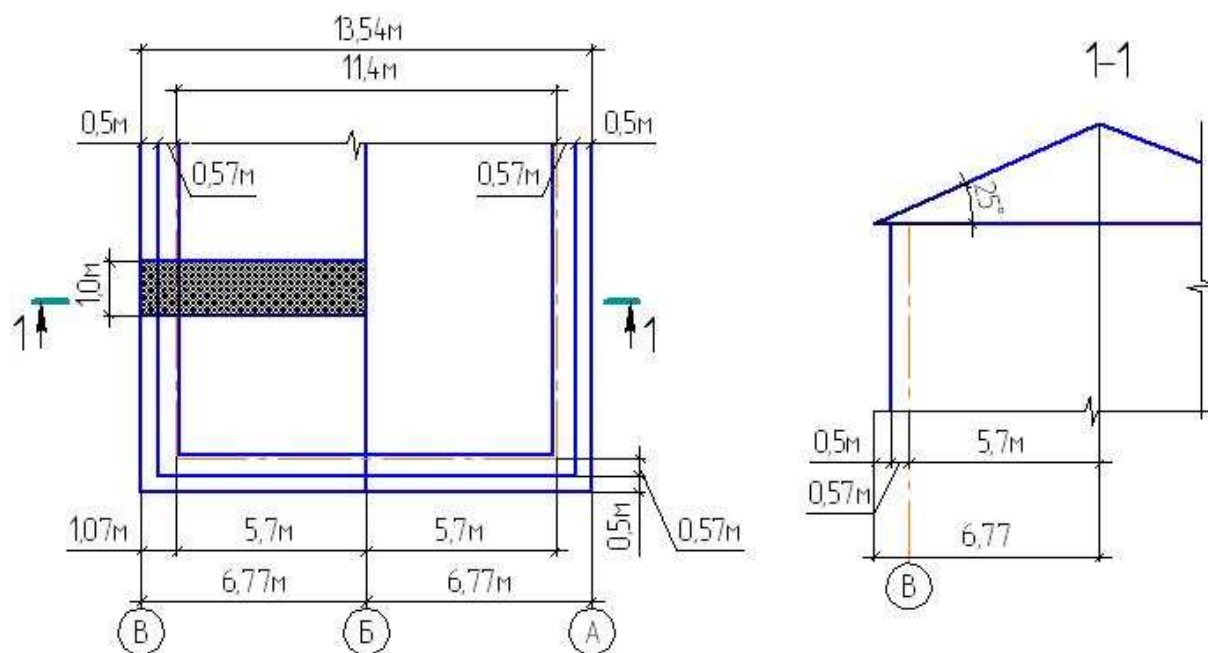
Схема к определению площади покрытия в сечении 1-1.
